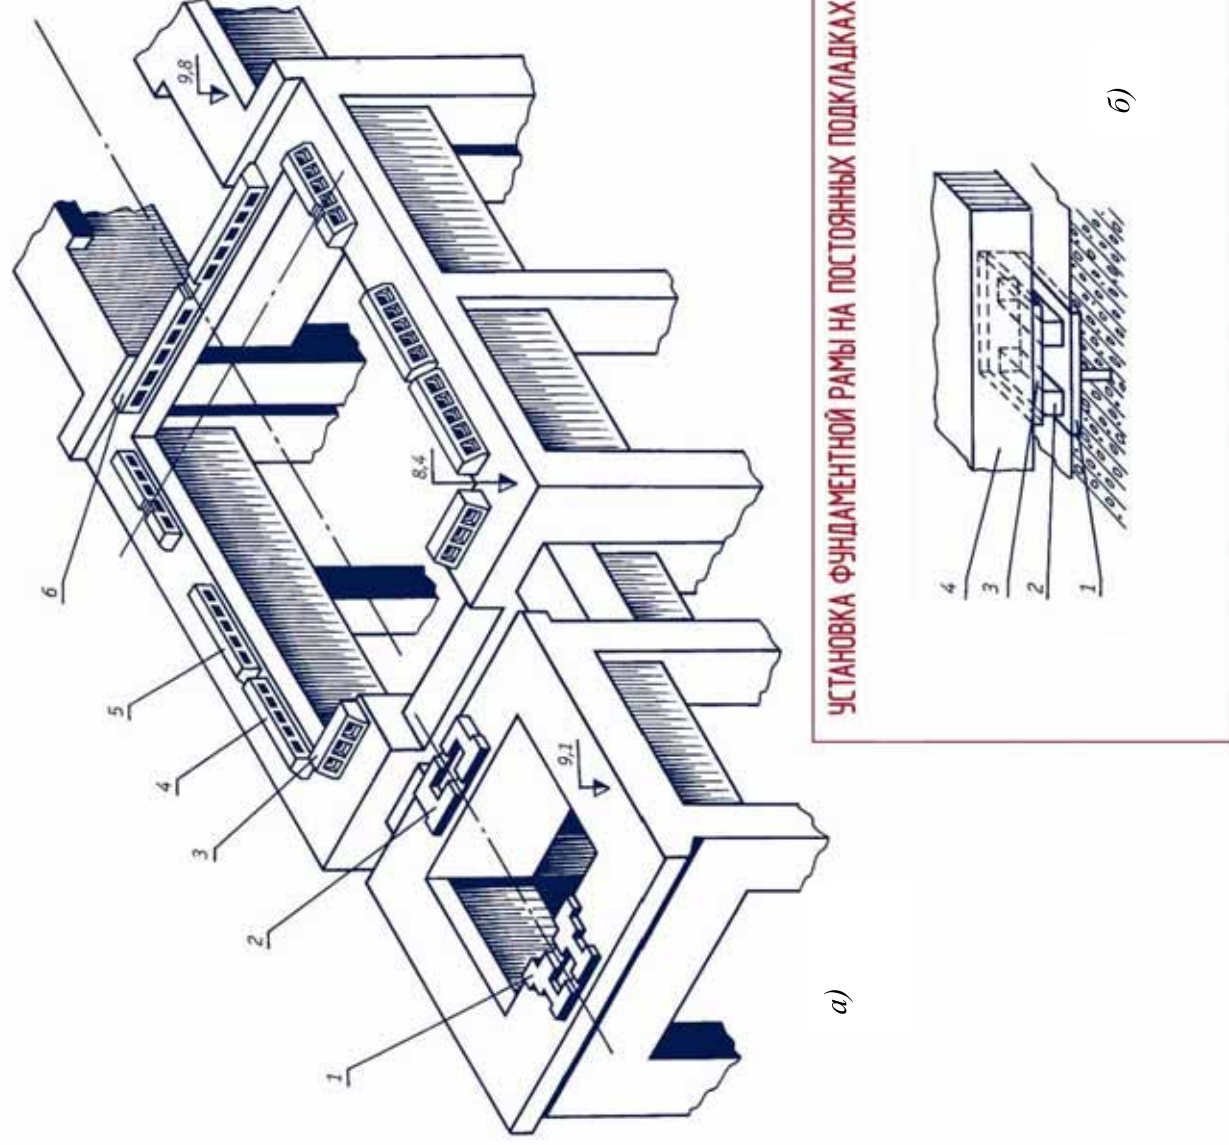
Расположение фундаментных рам на фундаменте турбины (а) и установка фундаментной рамы на постоянных подкладках (б): 1 – фундаментная рама передней опоры; 2 – фундаментная рама средней опоры; 3 – поперечные фундаментные рамы выходной части ЦСД; 4 – продольные фундаментные рамы выходной части ЦСД; 5 – продольные фундаментные рамы ЦНД; 6 – задняя поперечная фундаментная рама ЦНД. Для рис. б: 1 – закладная плита; 2 – опорный брус закладной плиты; 3 – постоянная подкладка; 4 – фундаментная рама
